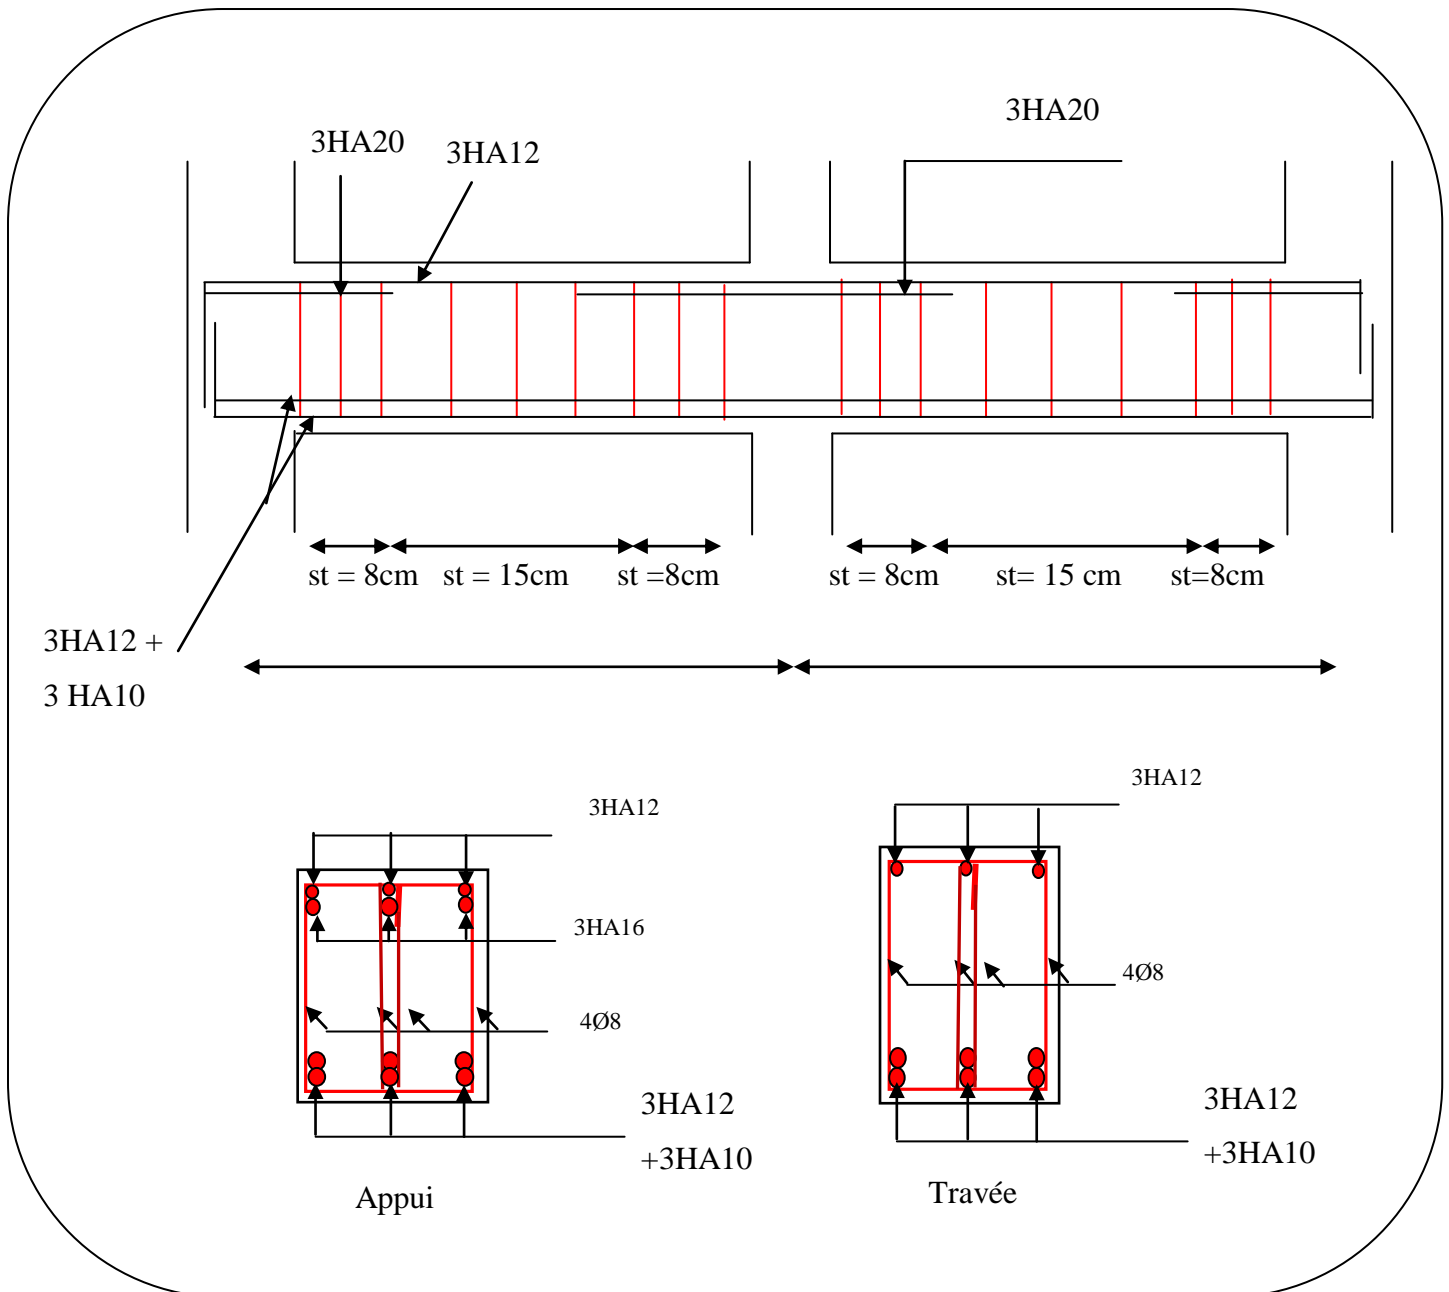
Schéma de ferrailage des poutres secondaires
